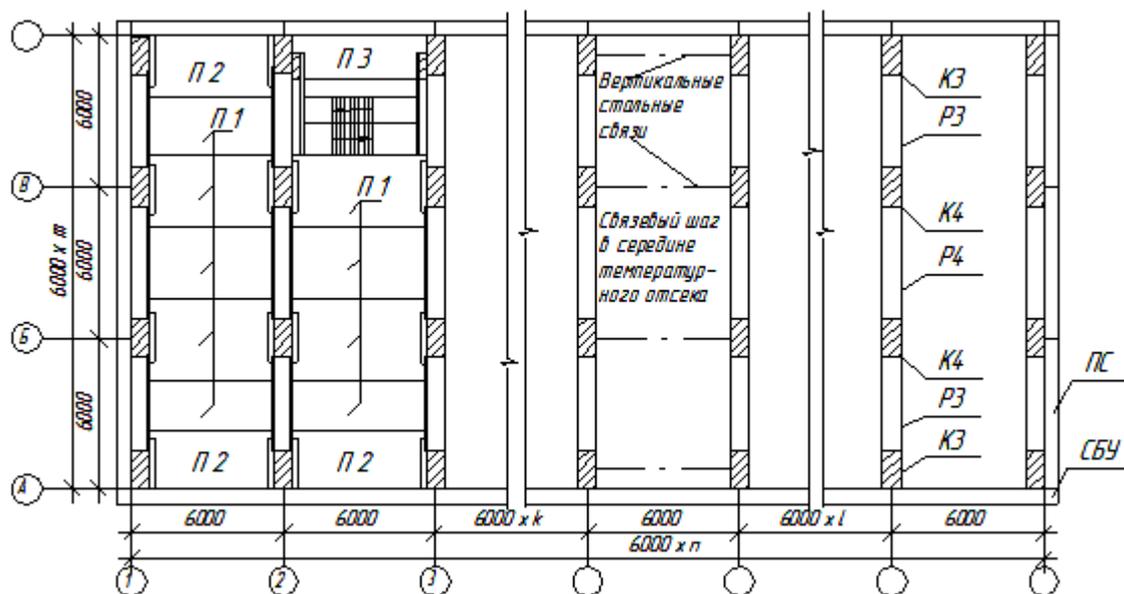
Схема плана с сеткой колонн 6×6 м (вариант 1)
